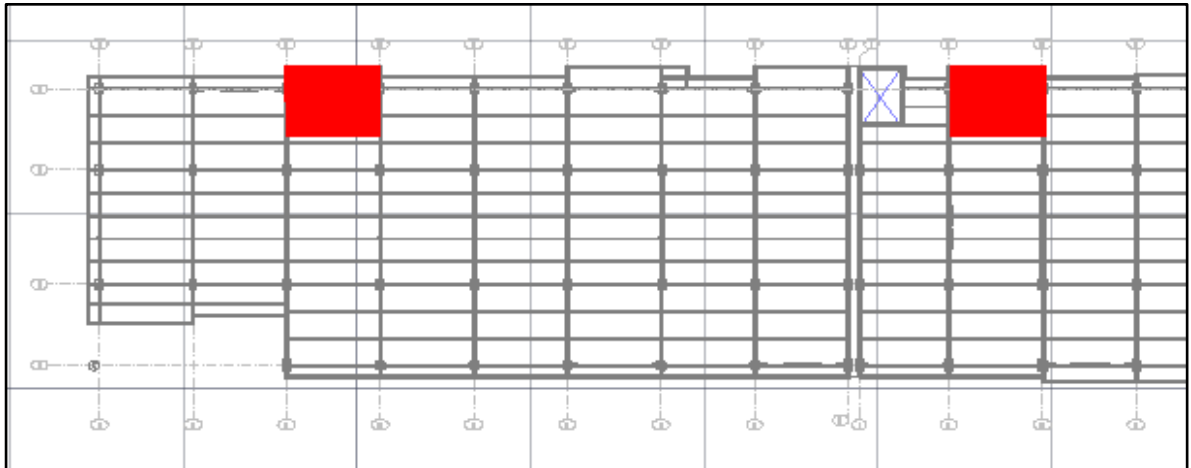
Localización de escaleras. Fuente: Plano de planta y alzada 14.0.
